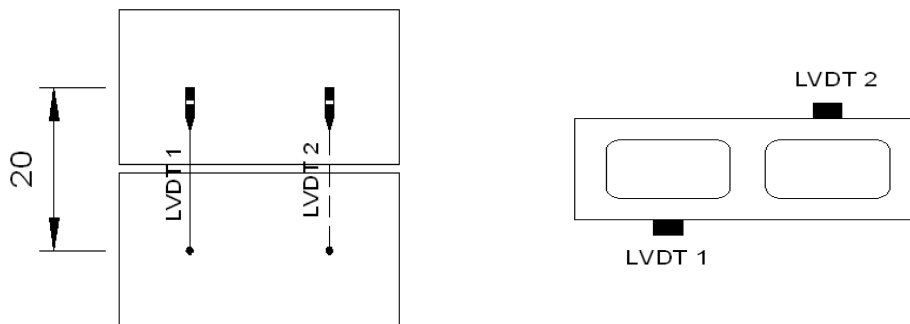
Vista frontal e em planta da localização dos transdutores de deslocamento nos prismas
